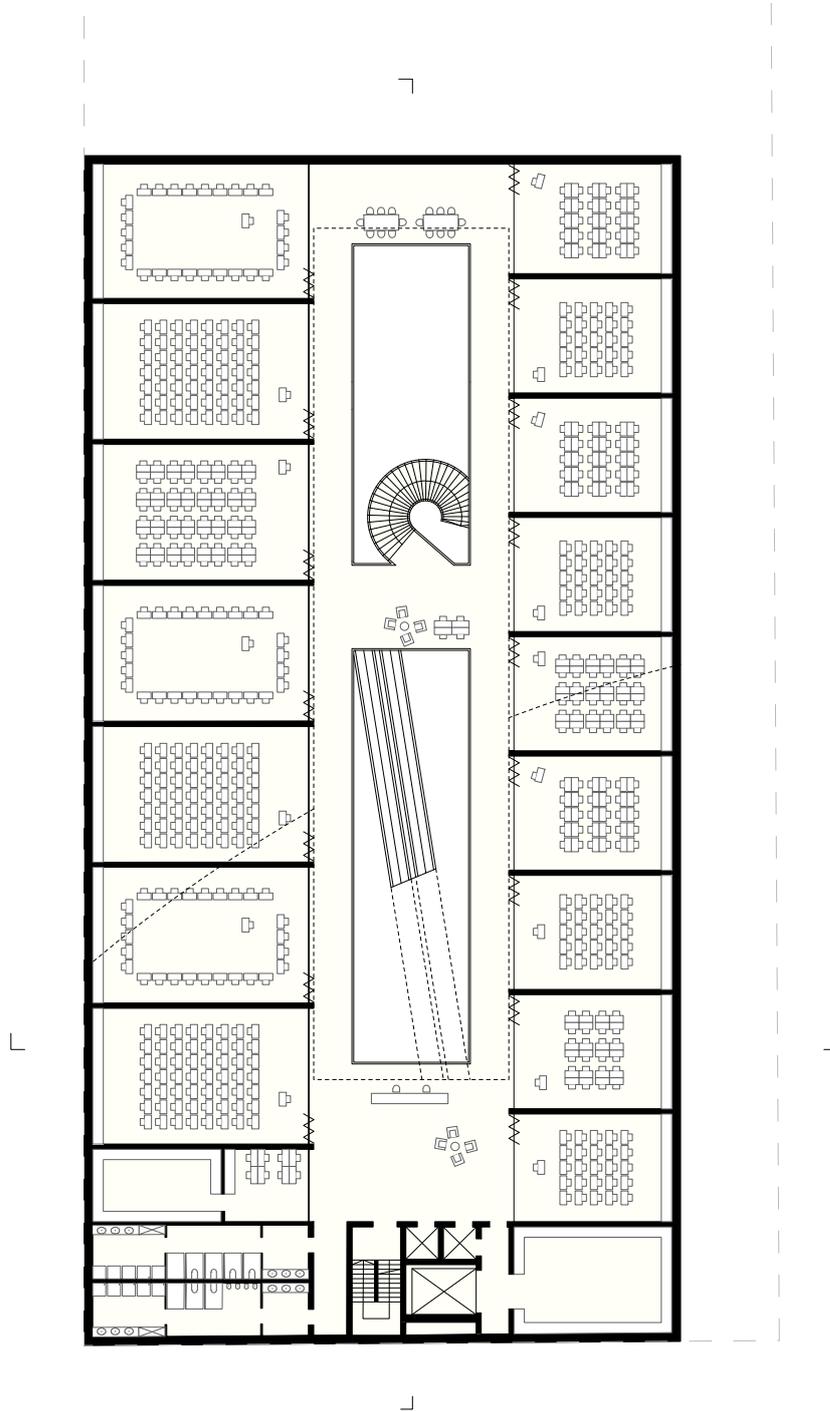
Wettbewerbsbeitrag Grundriss Untergeschoß 1
